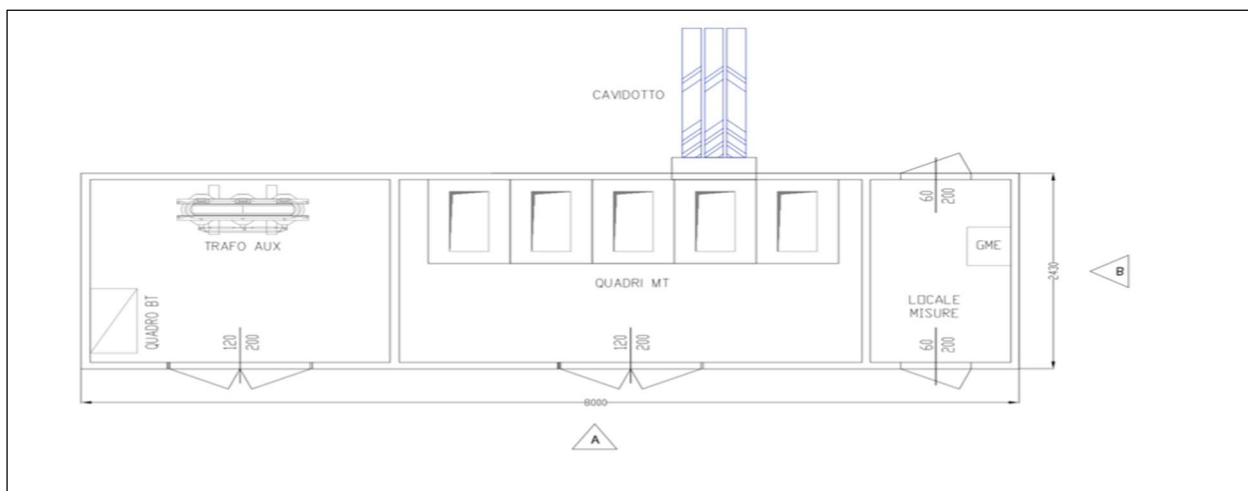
Locale cabina di Parallelo Mt-pianta
